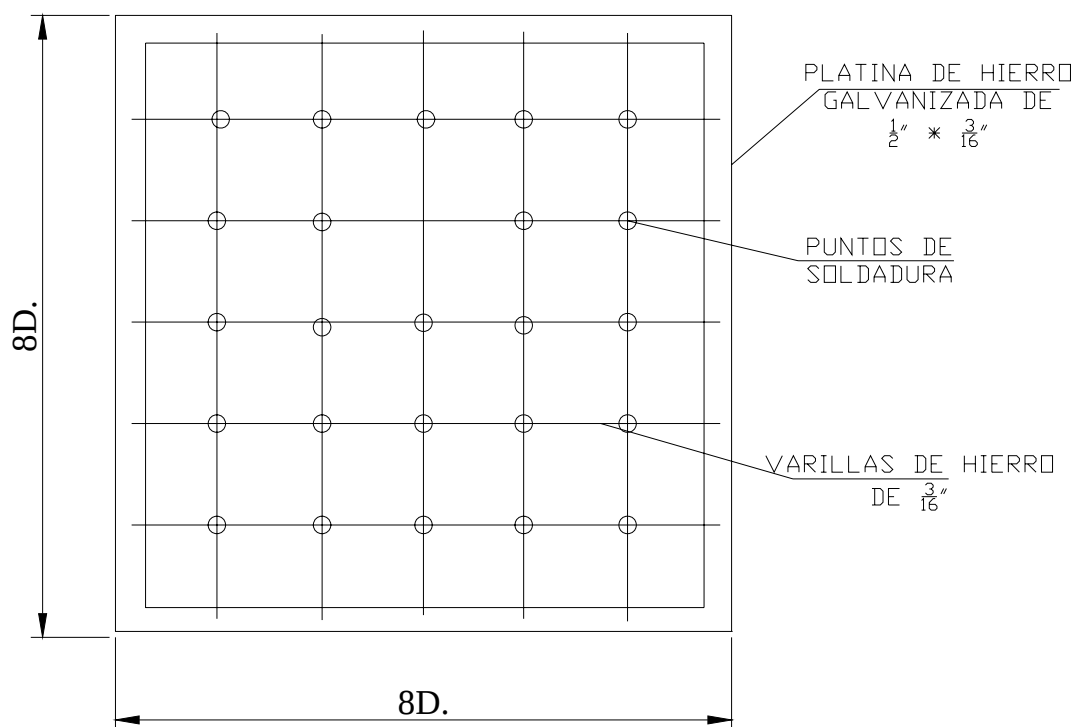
Refuerzo metálico para caja de inspección BT.
